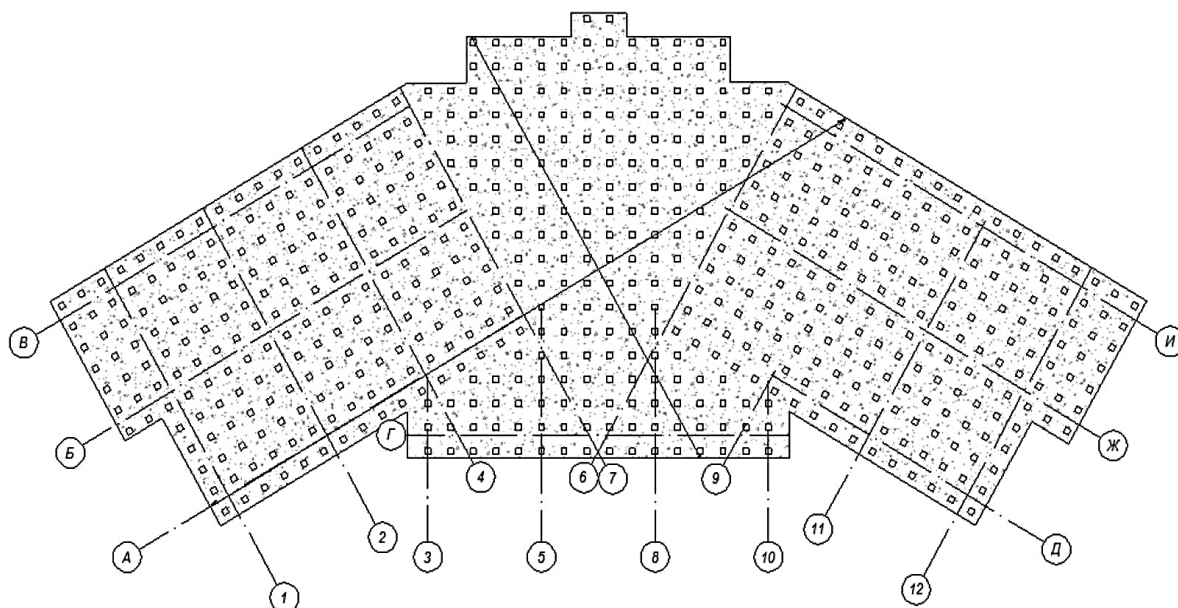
Опалубне креслення монолітної плити фундаменту із забивними палями
